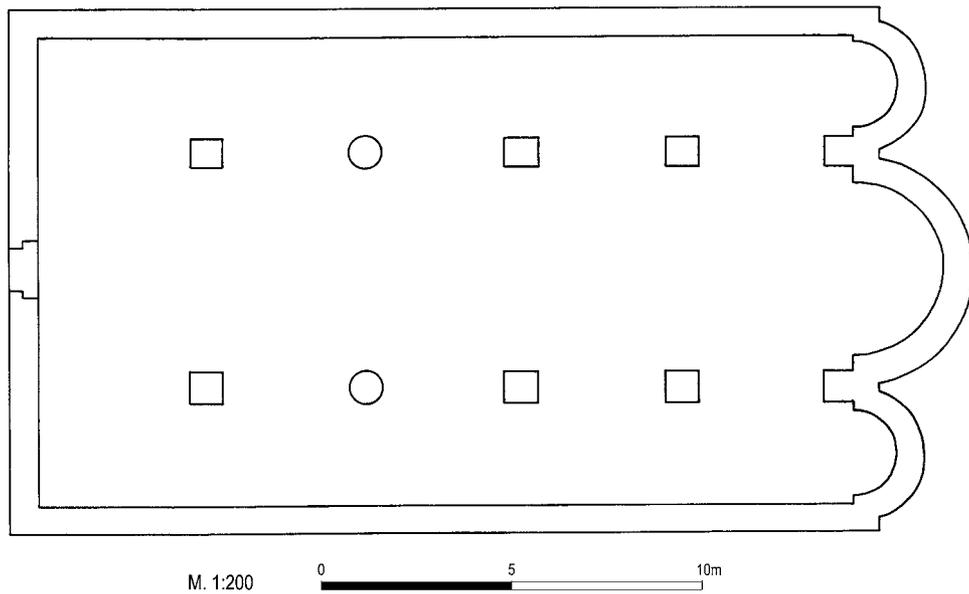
Petersberg, Gde. Erdweg, Lkr. Dachau. Grundriss der Basilika.
